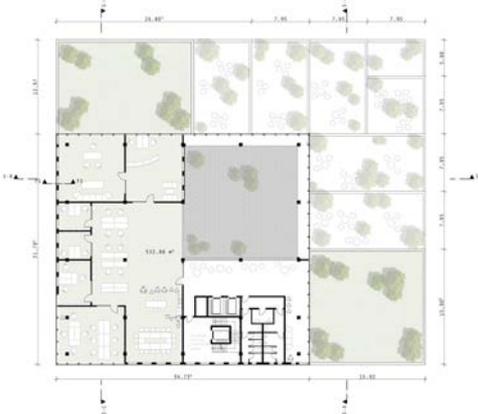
Grundriss 21.-24.Obergeschoss
